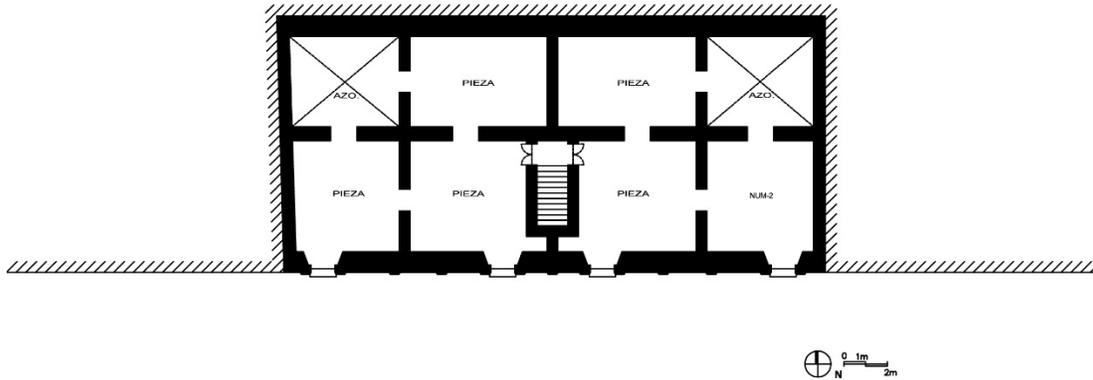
Planta de las Casas de los Camilos. Se observan los muros de carga masivos.
